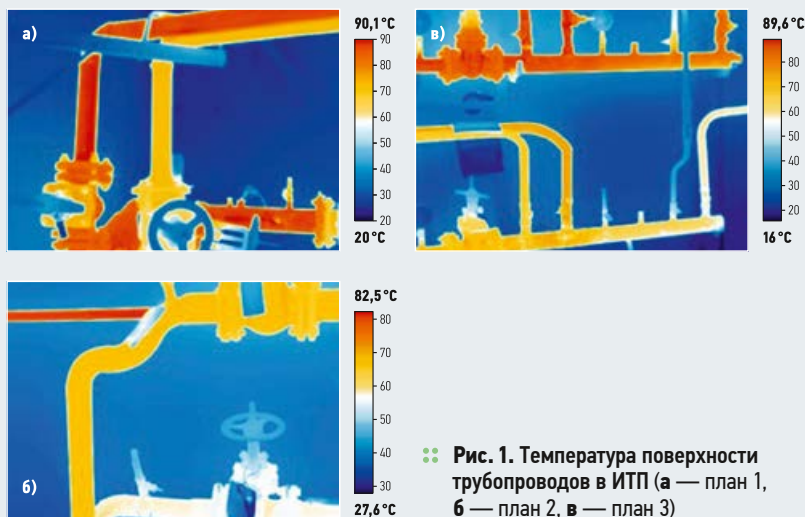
Температура поверхности трубопроводов в ИТП (а — план 1, б — план 2, в — план 3)
